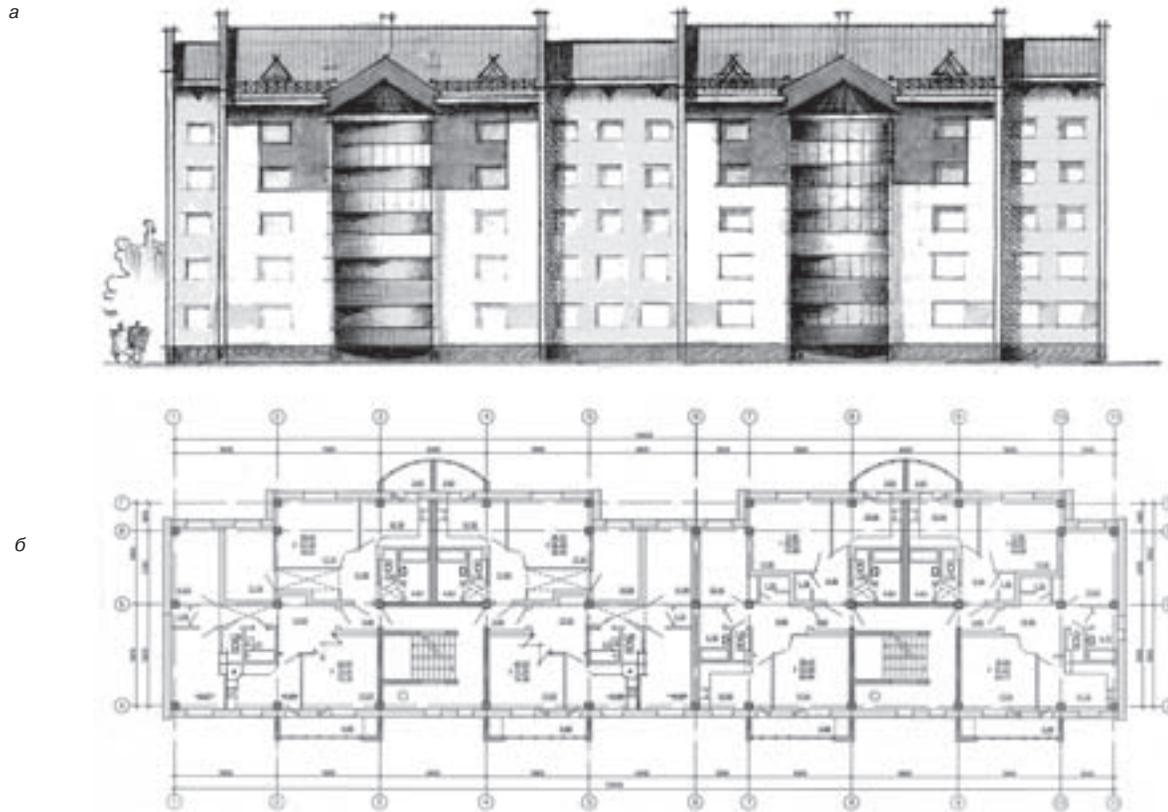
Экспериментальный 5-этажный 40-квартирный жилой дом на основе сборного каркаса с наружными стеновыми панелями из ячеистого бетона: а – главный фасад; б – план типового этажа
